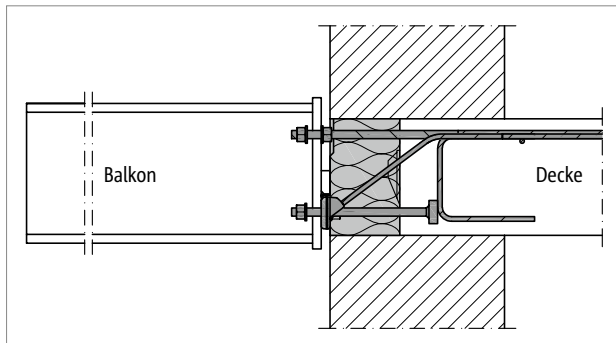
Schöck Isokorb® XT Typ SK: Anschluss an die Stahlbetondecke; monolithische Konstruktion der Wand
